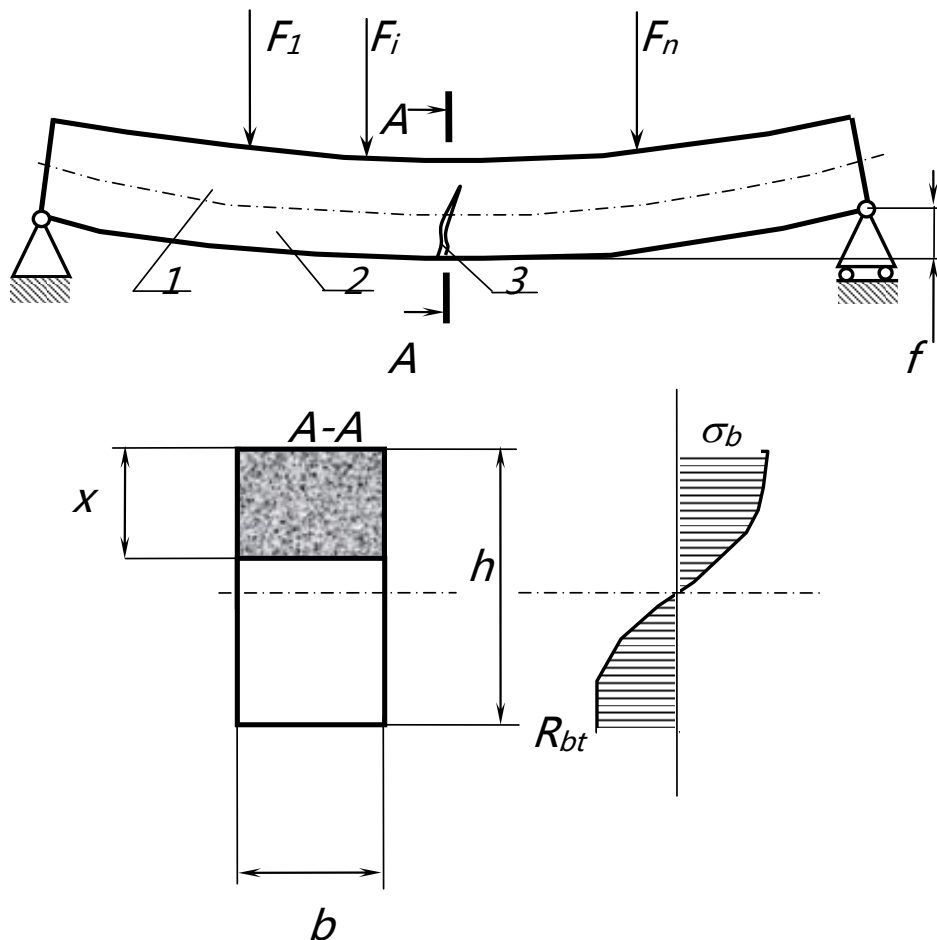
Схема роботи бетонної балки на згин: 1 – стиснута зона; 2 – розтягнута зона; 3 – тріщина, що спричиняє руйнування балки; F – силове навантаження; f – величина прогину балки
